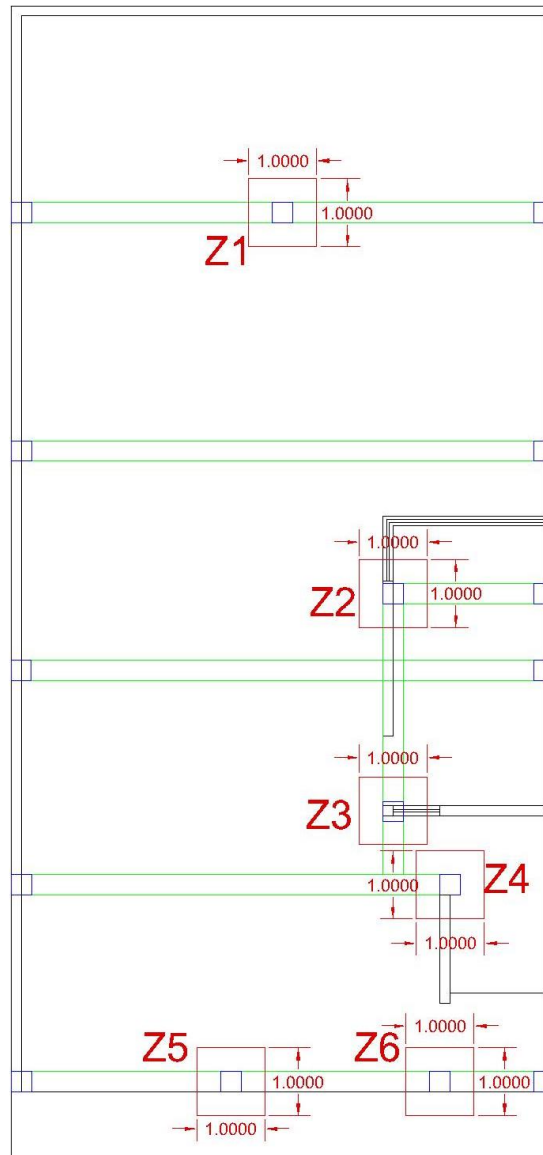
Zapatas aisladas de 1 x 1 m. con varilla de 3/8 @ 15cm. c. a. c.
